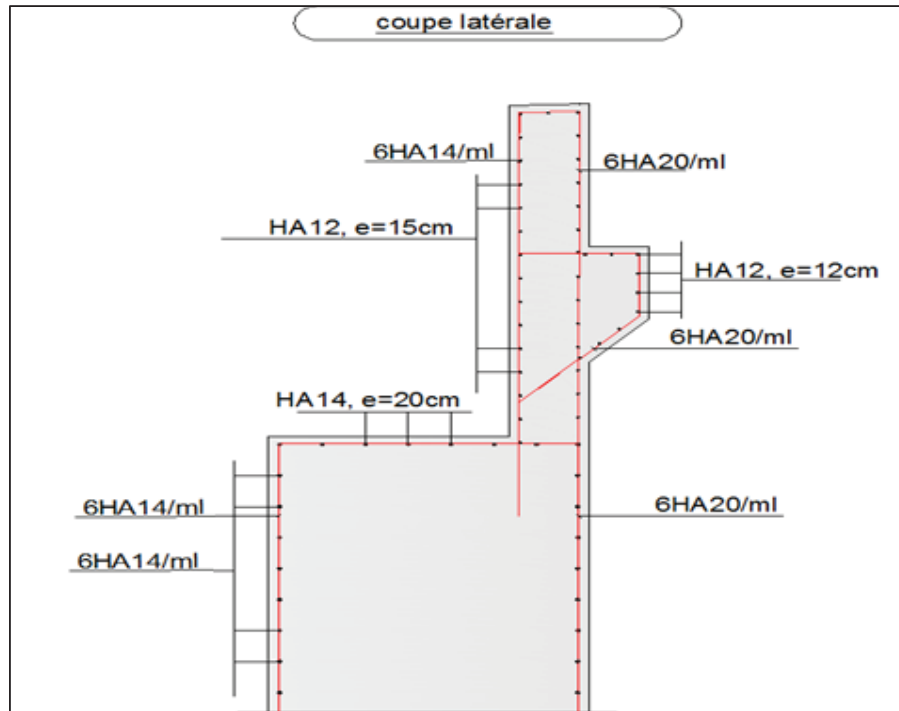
Ferrailage du mur garde grève + corbeau + mur frontale
